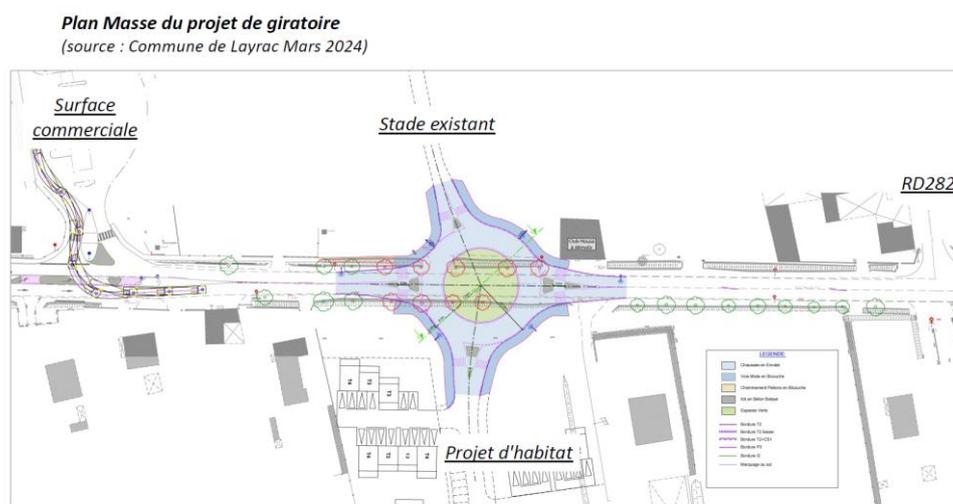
Plan du giratoire et de la bretelle de sortie au sud (source : dossier)
